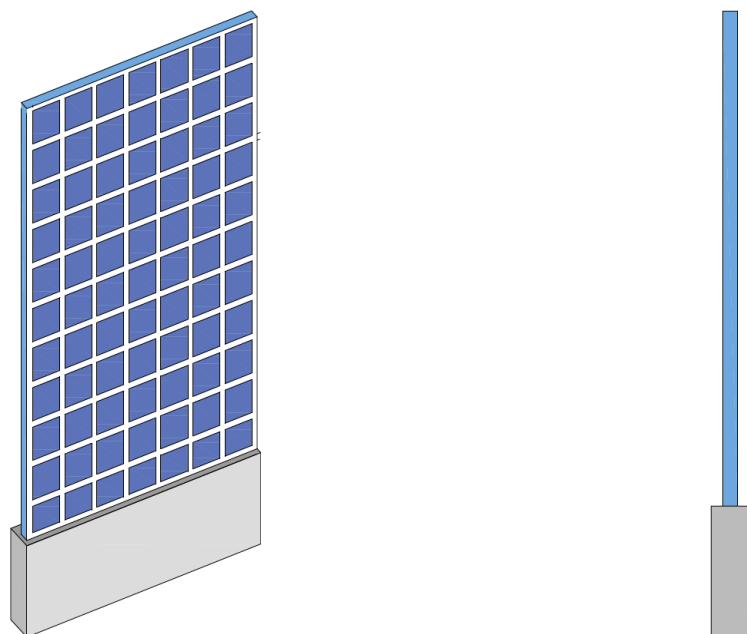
Řadová konstrukce (typ 2) ^[107]
